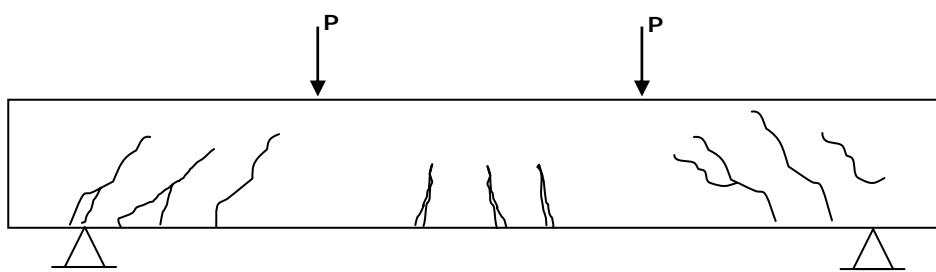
Fissuras Verticais (Flexão Pura) – Fissuras Inclinadas (Flexão Simples) – Estádio II
